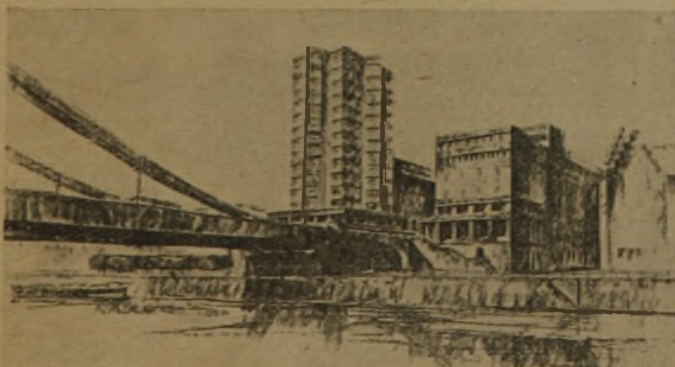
u. 37. Schaubild und Grundriß Ladengeschoß.
